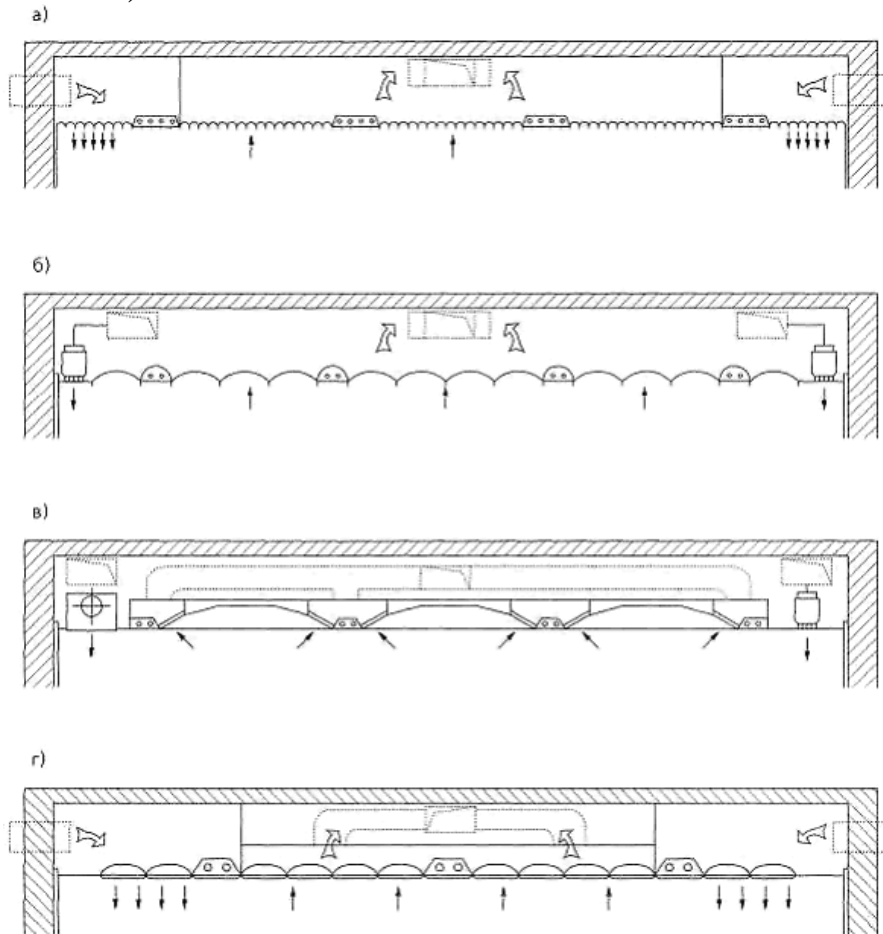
Вентильовані стелі: а) відкрита вентильована стеля зі знімними фільтрами; б) відкрита вентильована стеля зі знімними фільтрами і жолобами для збору конденсату; в) закрита вентильована стеля з ізолюваними припливними і витяжними повітроводами; г) закрита вентильована стеля з витяжними повітроводами і відкритою подачею припливного повітря
